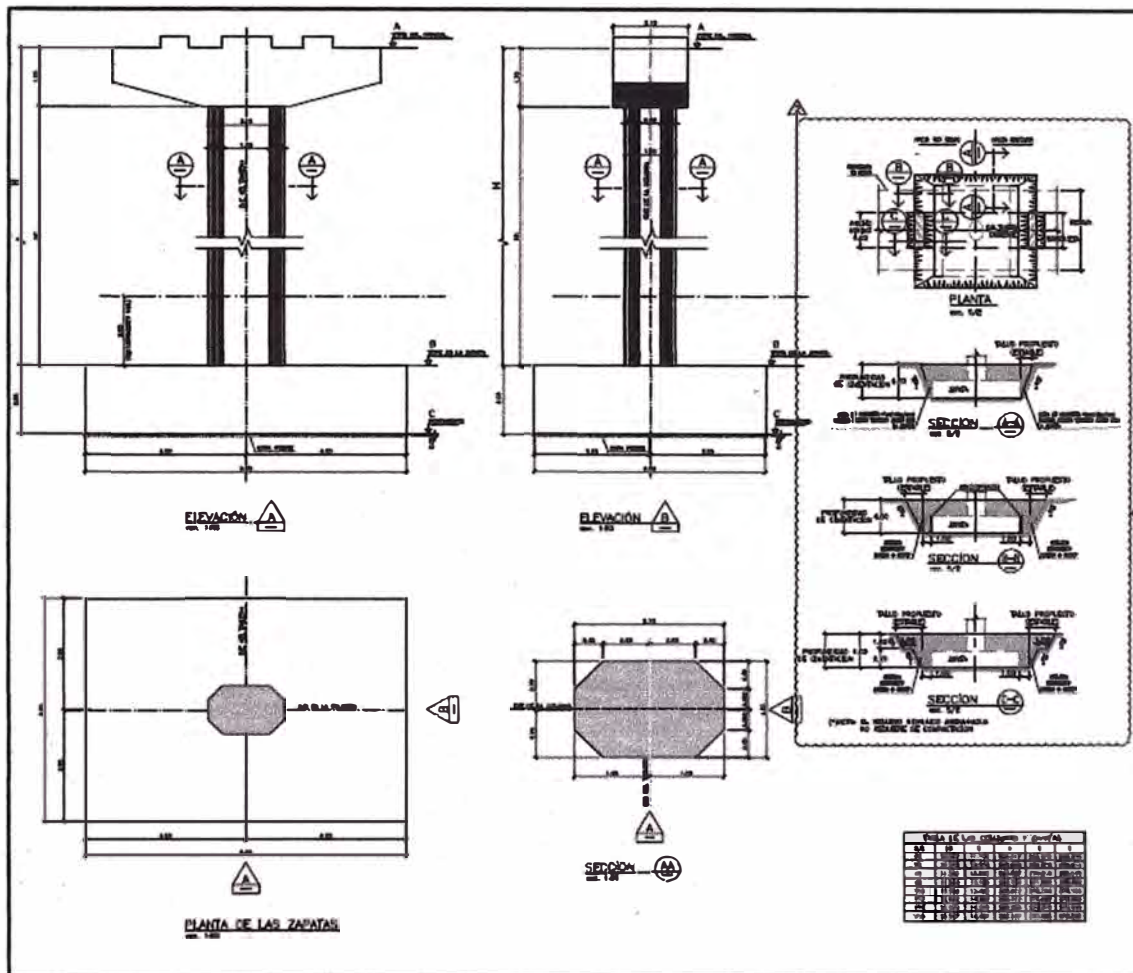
Plano para construcción Típico de la Zapata y Columna del Viaducto.
